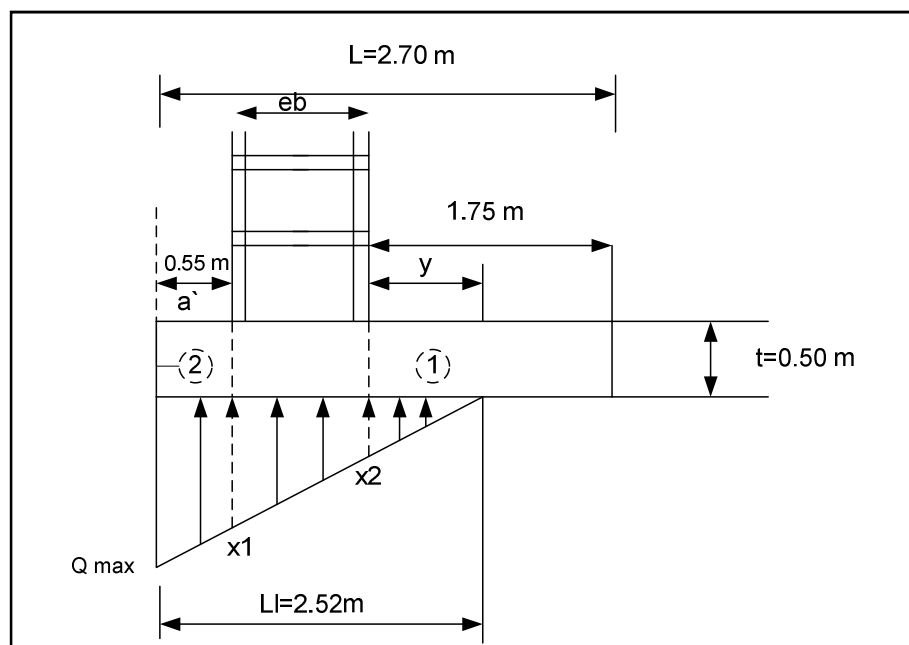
Placa de cimentación muro de retención de mampostería reforzada de 3 metros
